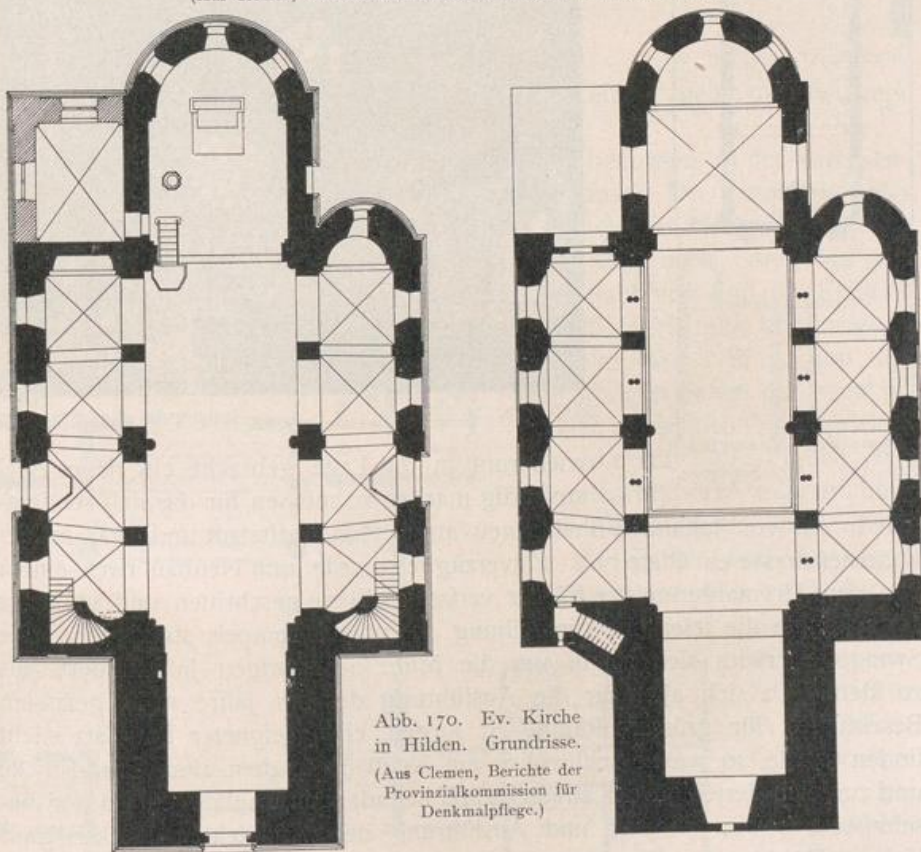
Ev. Kirche in Hilden. Grundrisse.
